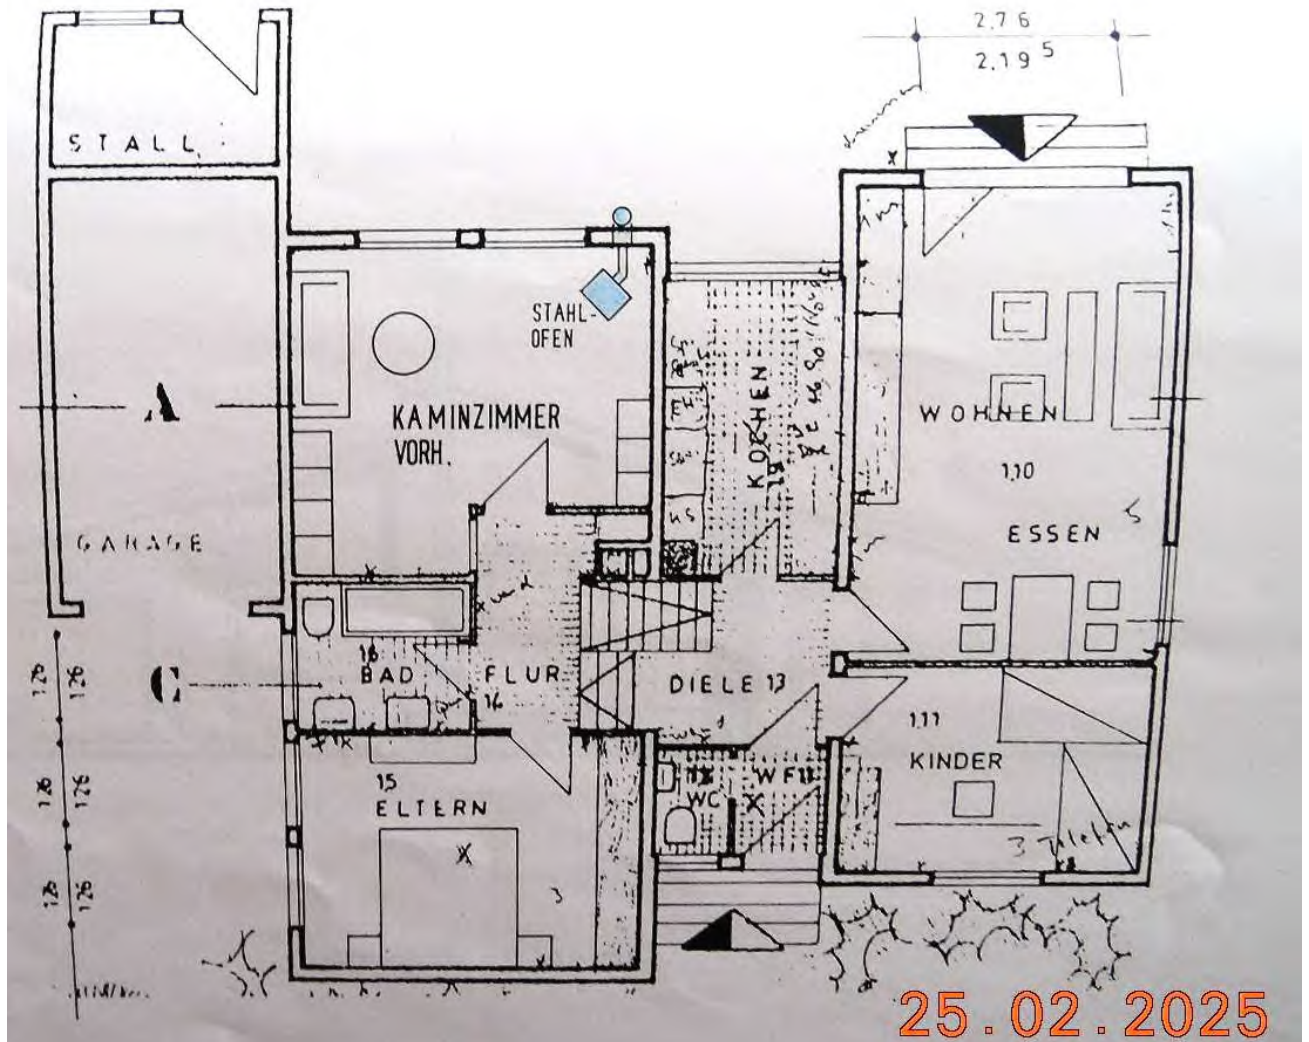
Grundrissplan Erdgeschoss (aus Bauakte 2002)
